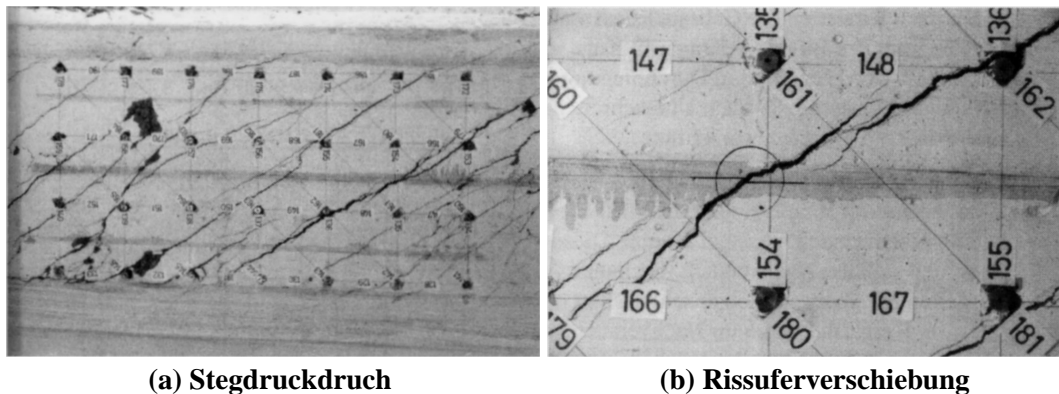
Bruchbild vom Stahlbetonbalken III ($\rho_w = 1.2 \text{ ‰}$) nach Reineck et al. [130]
